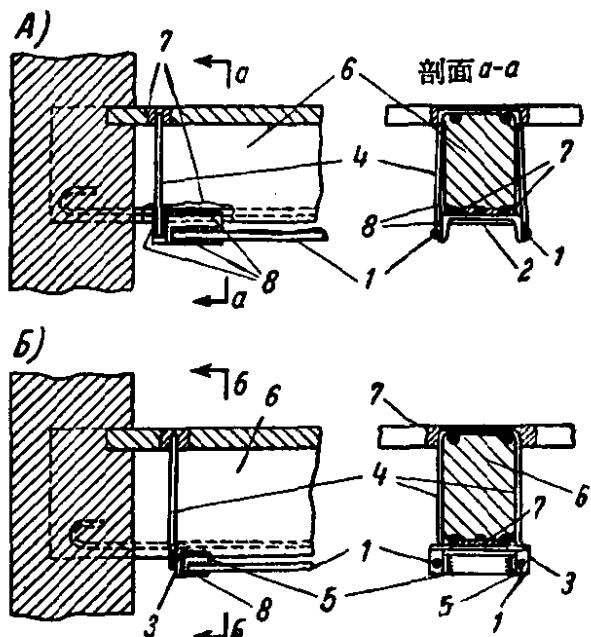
钢筋混凝土构件边支座上水平补强拉杆的锚固装置结构
